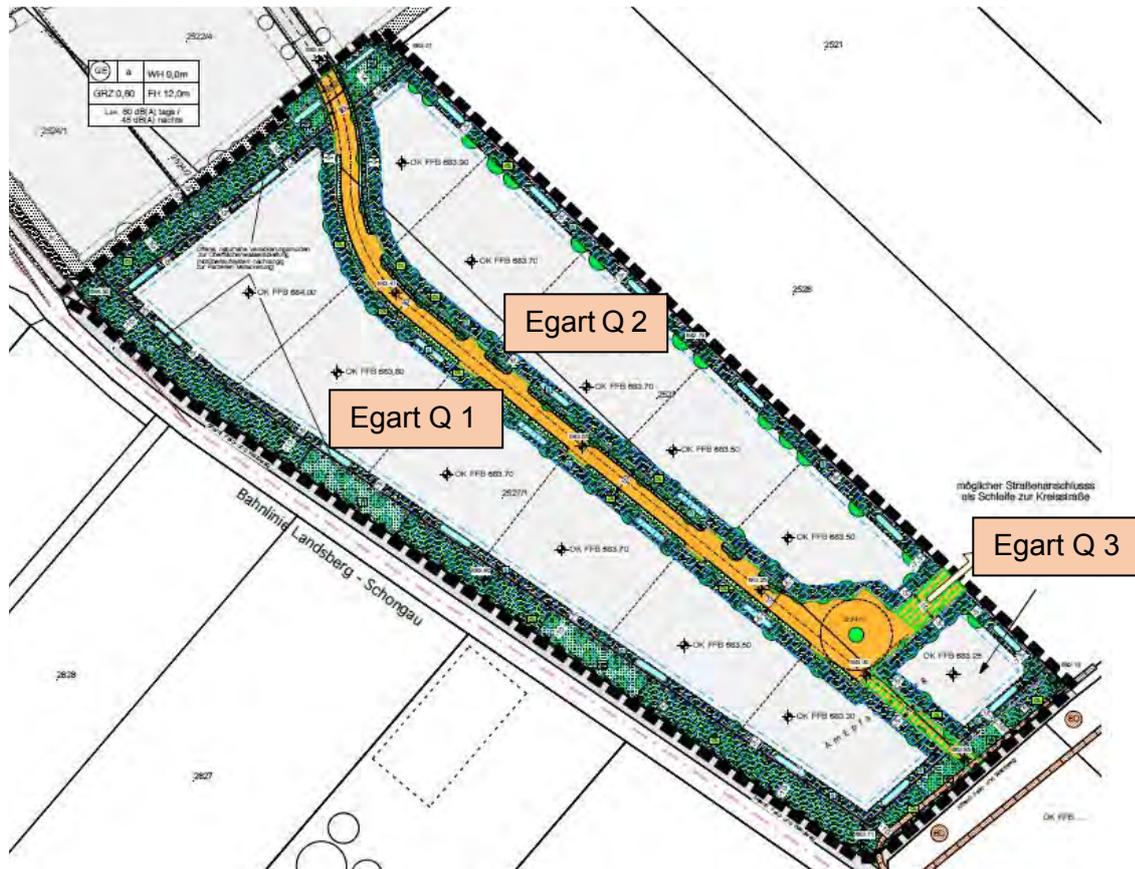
Auszug aus dem Entwurf des Bebauungsplans, genordet, Quelle Architekturbüro Reiser
